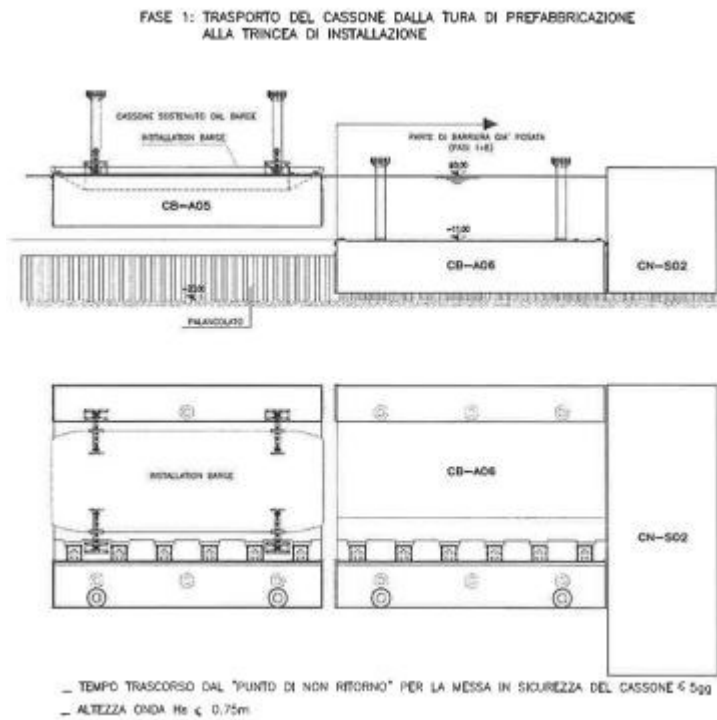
Fase 1 – Cassone in affondamento; estratto dagli elaborati grafici AS BUILT.
